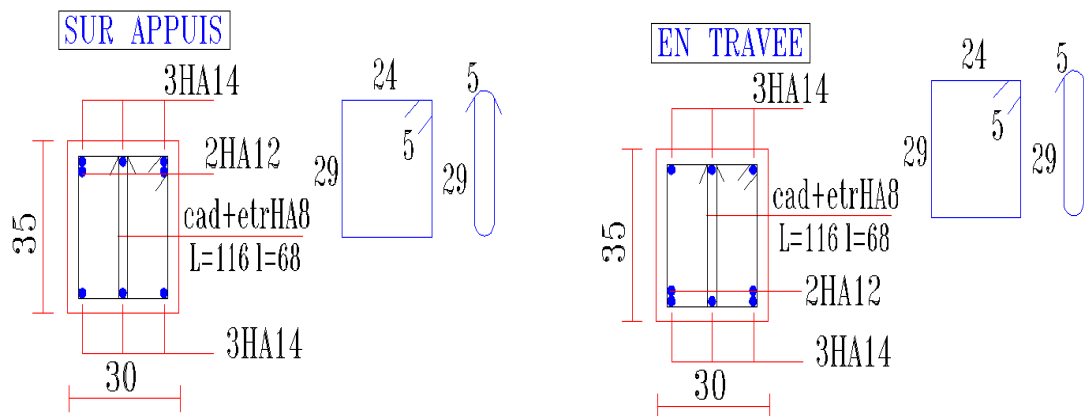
Schéma de ferraillage de la poutre secondaire
